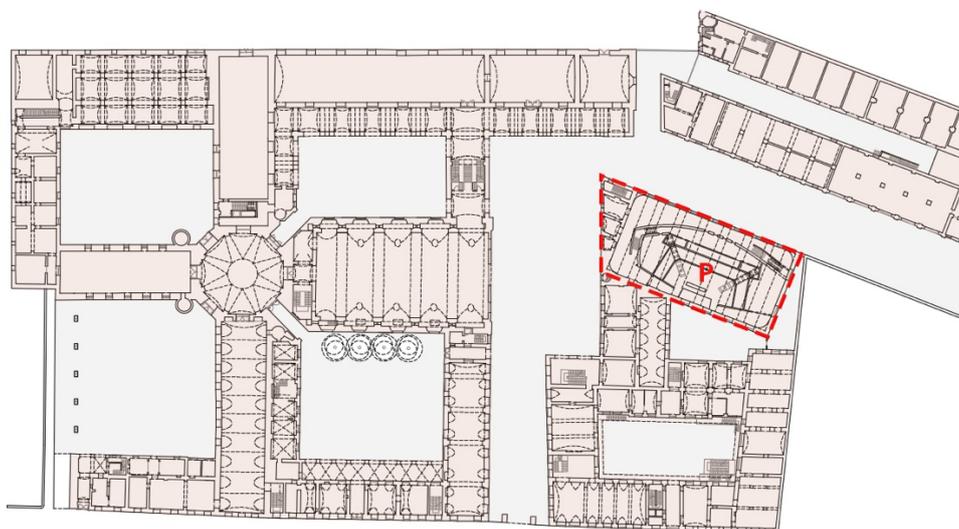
planimetria con evidenza edificio P - elaborazione personale
